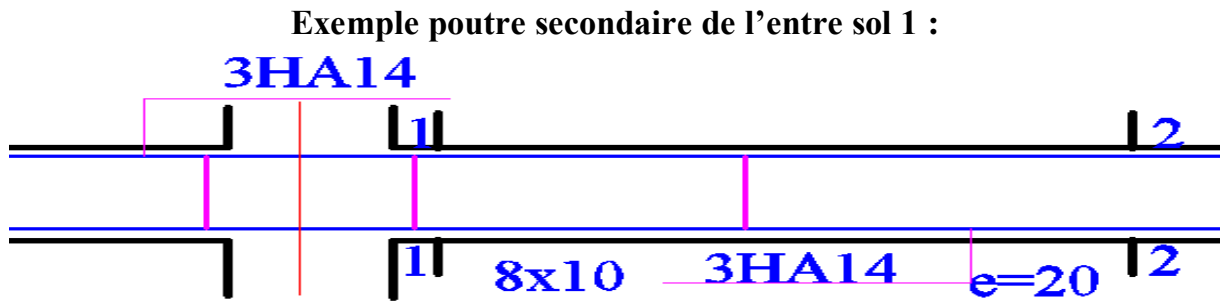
Exemple poutre secondaire de l'entre sol 1.
